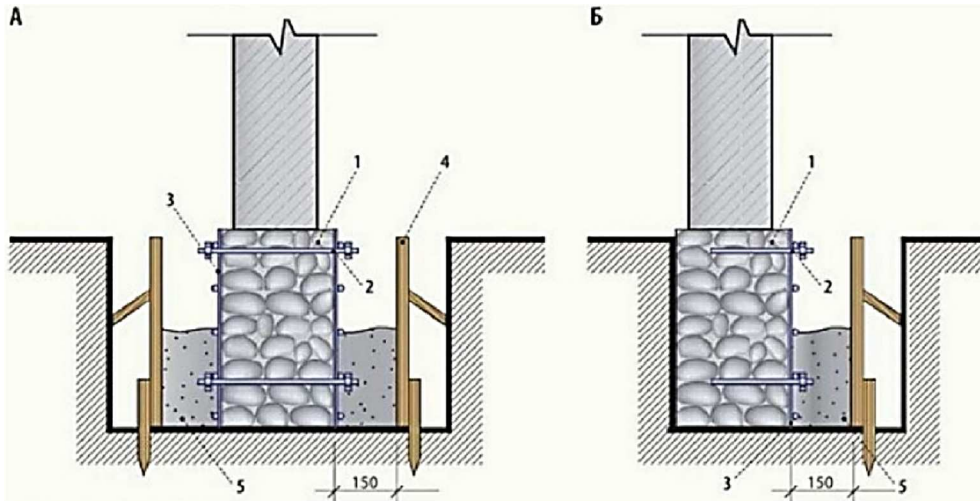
Усиление фундаментов методом цементации пустот в кладке
